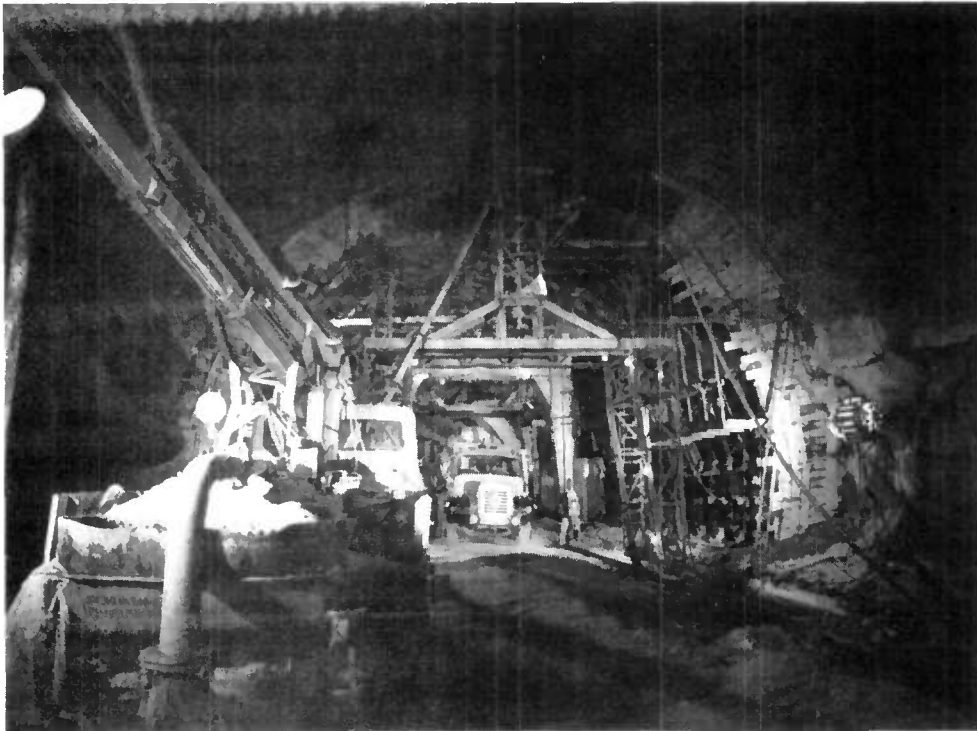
Autoroute A. 8. - Tunnel de Las Planas.
